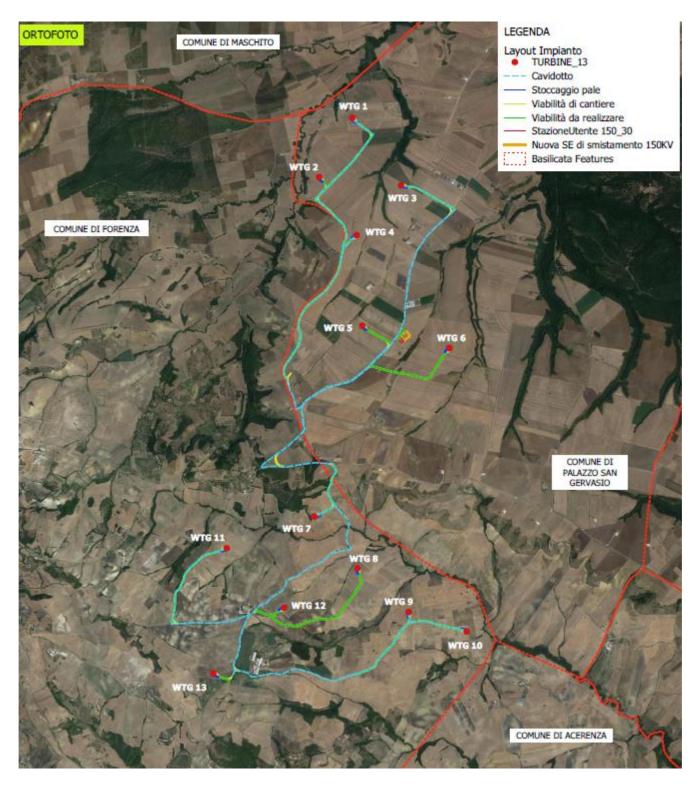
Area di intervento: dettaglio layout di progetto su ortofoto
